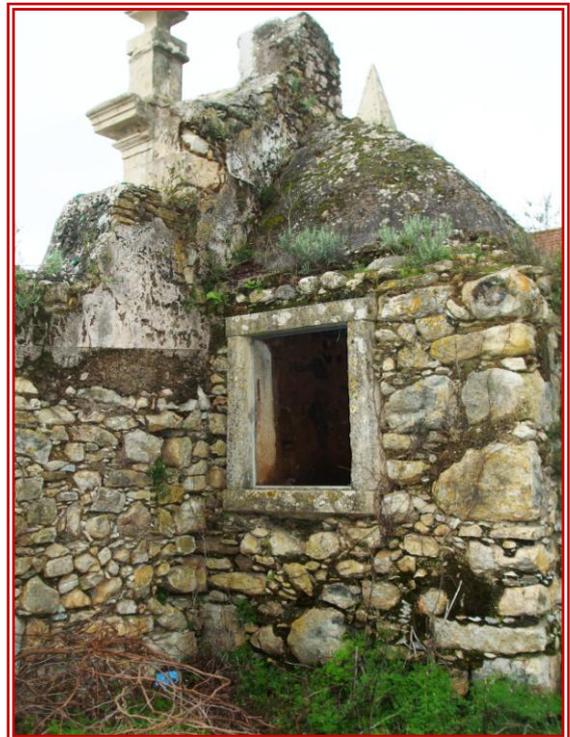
Descargas das águas pluviais da caleira adjacente.
